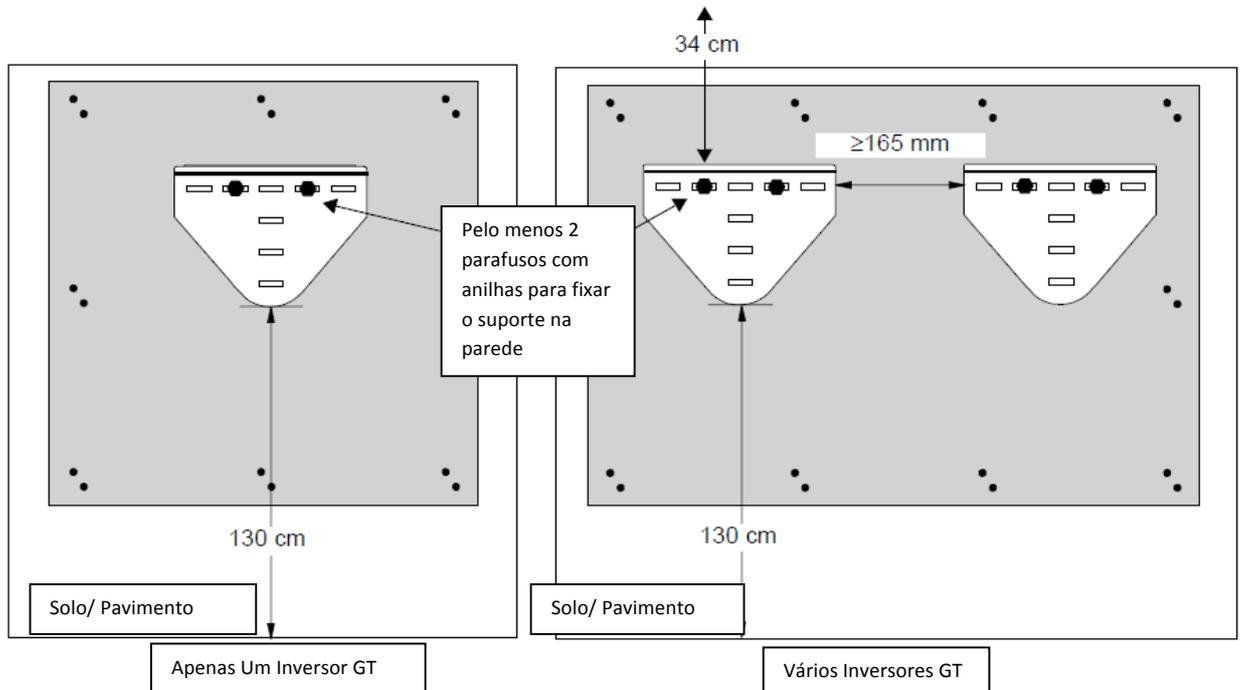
Instalação do Suporte de Montagem utilizando o Apoio em contraplacado
